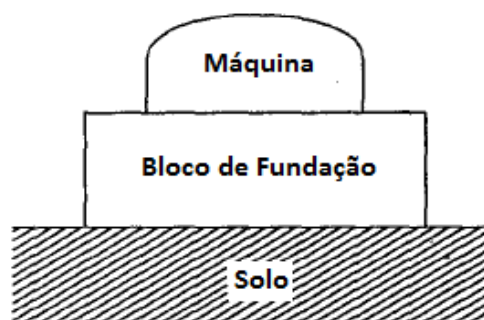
Fundação em bloco de concreto apoiado diretamente em solo
